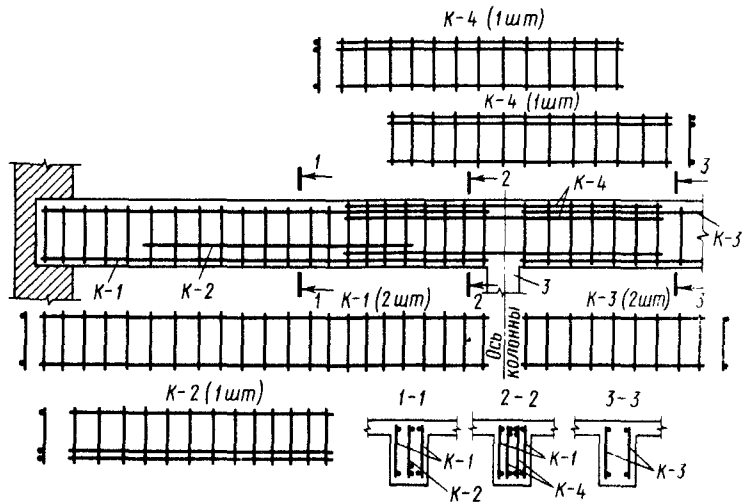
Армирование главной балки сварными каркасами: К-1, К-3 — сквозные пролетные каркасы; К-2 — пролетные каркасы, обрываемые в пролете; К-4 — опорные каркасы, сдвигаемые друг относительно друга в соответствии с эпюрой моментов
